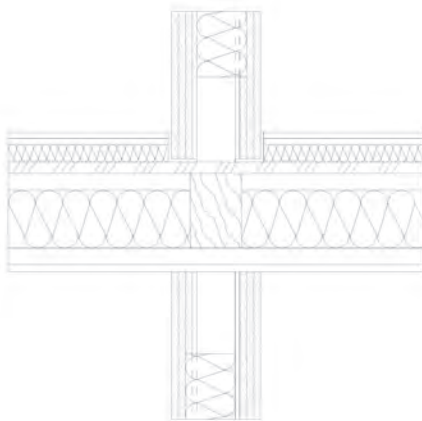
Schallübertragung von Metallständerwänden über eine Holzbalken oder Massivholzdecke (Quelle: Baradiy)
